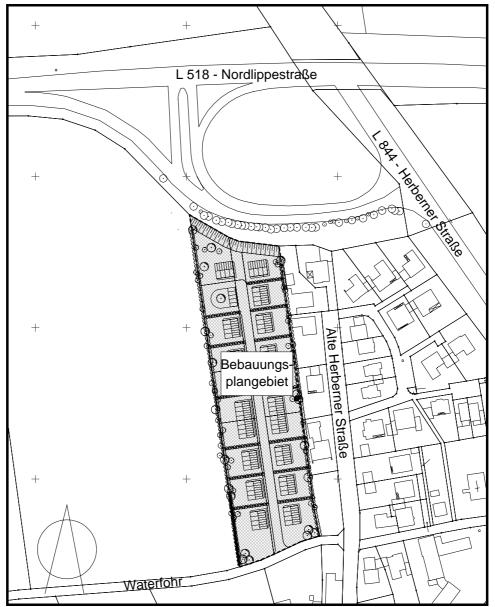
Lageplan, Städtebaulicher Entwurf, Bebauungsplan Nr. 3 "Waterfohr", Maßstab 1:2500
